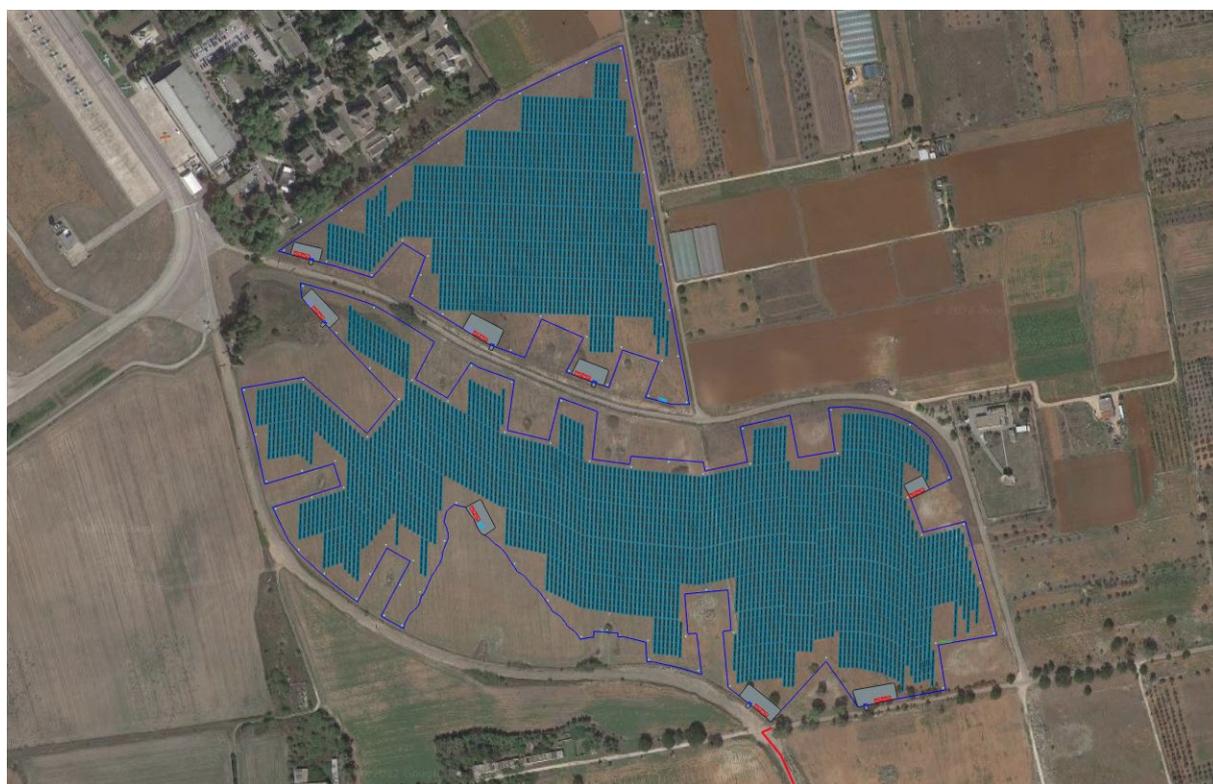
Progetto Pinta su ortofoto (layout Fotovoltaico)
